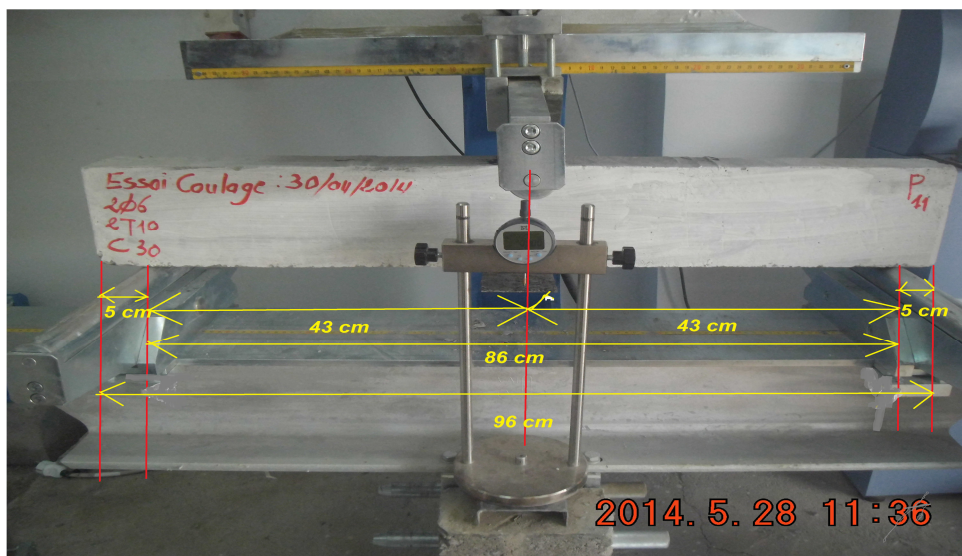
III.2 : Essai de flexion type sur une poutre en béton armé.
